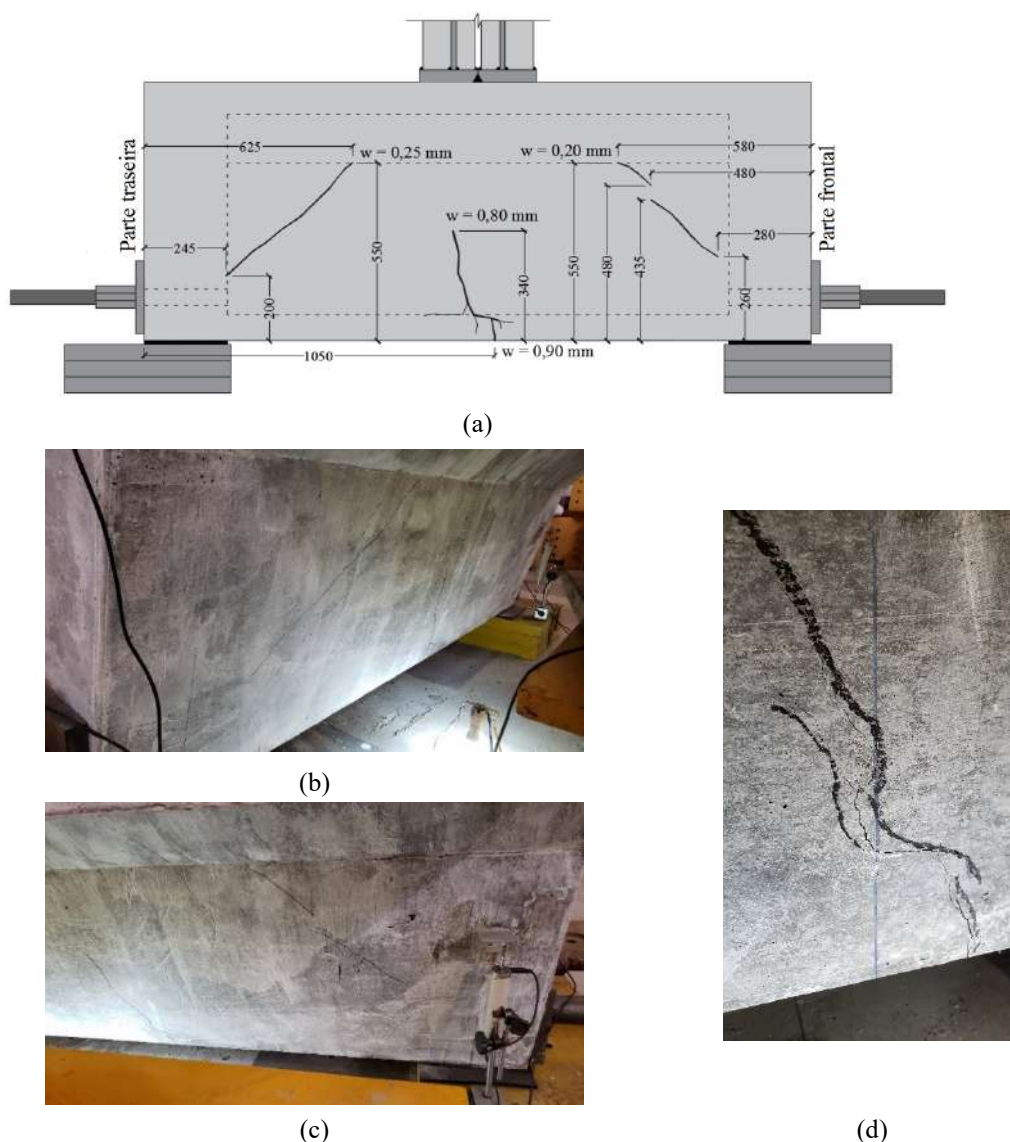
Registro das fissuras no lado direito: (a) mapeamento, (b) fissuras de cisalhamento no apoio traseiro, (c) e no apoio frontal, (d) e de flexão no meio do vão.
